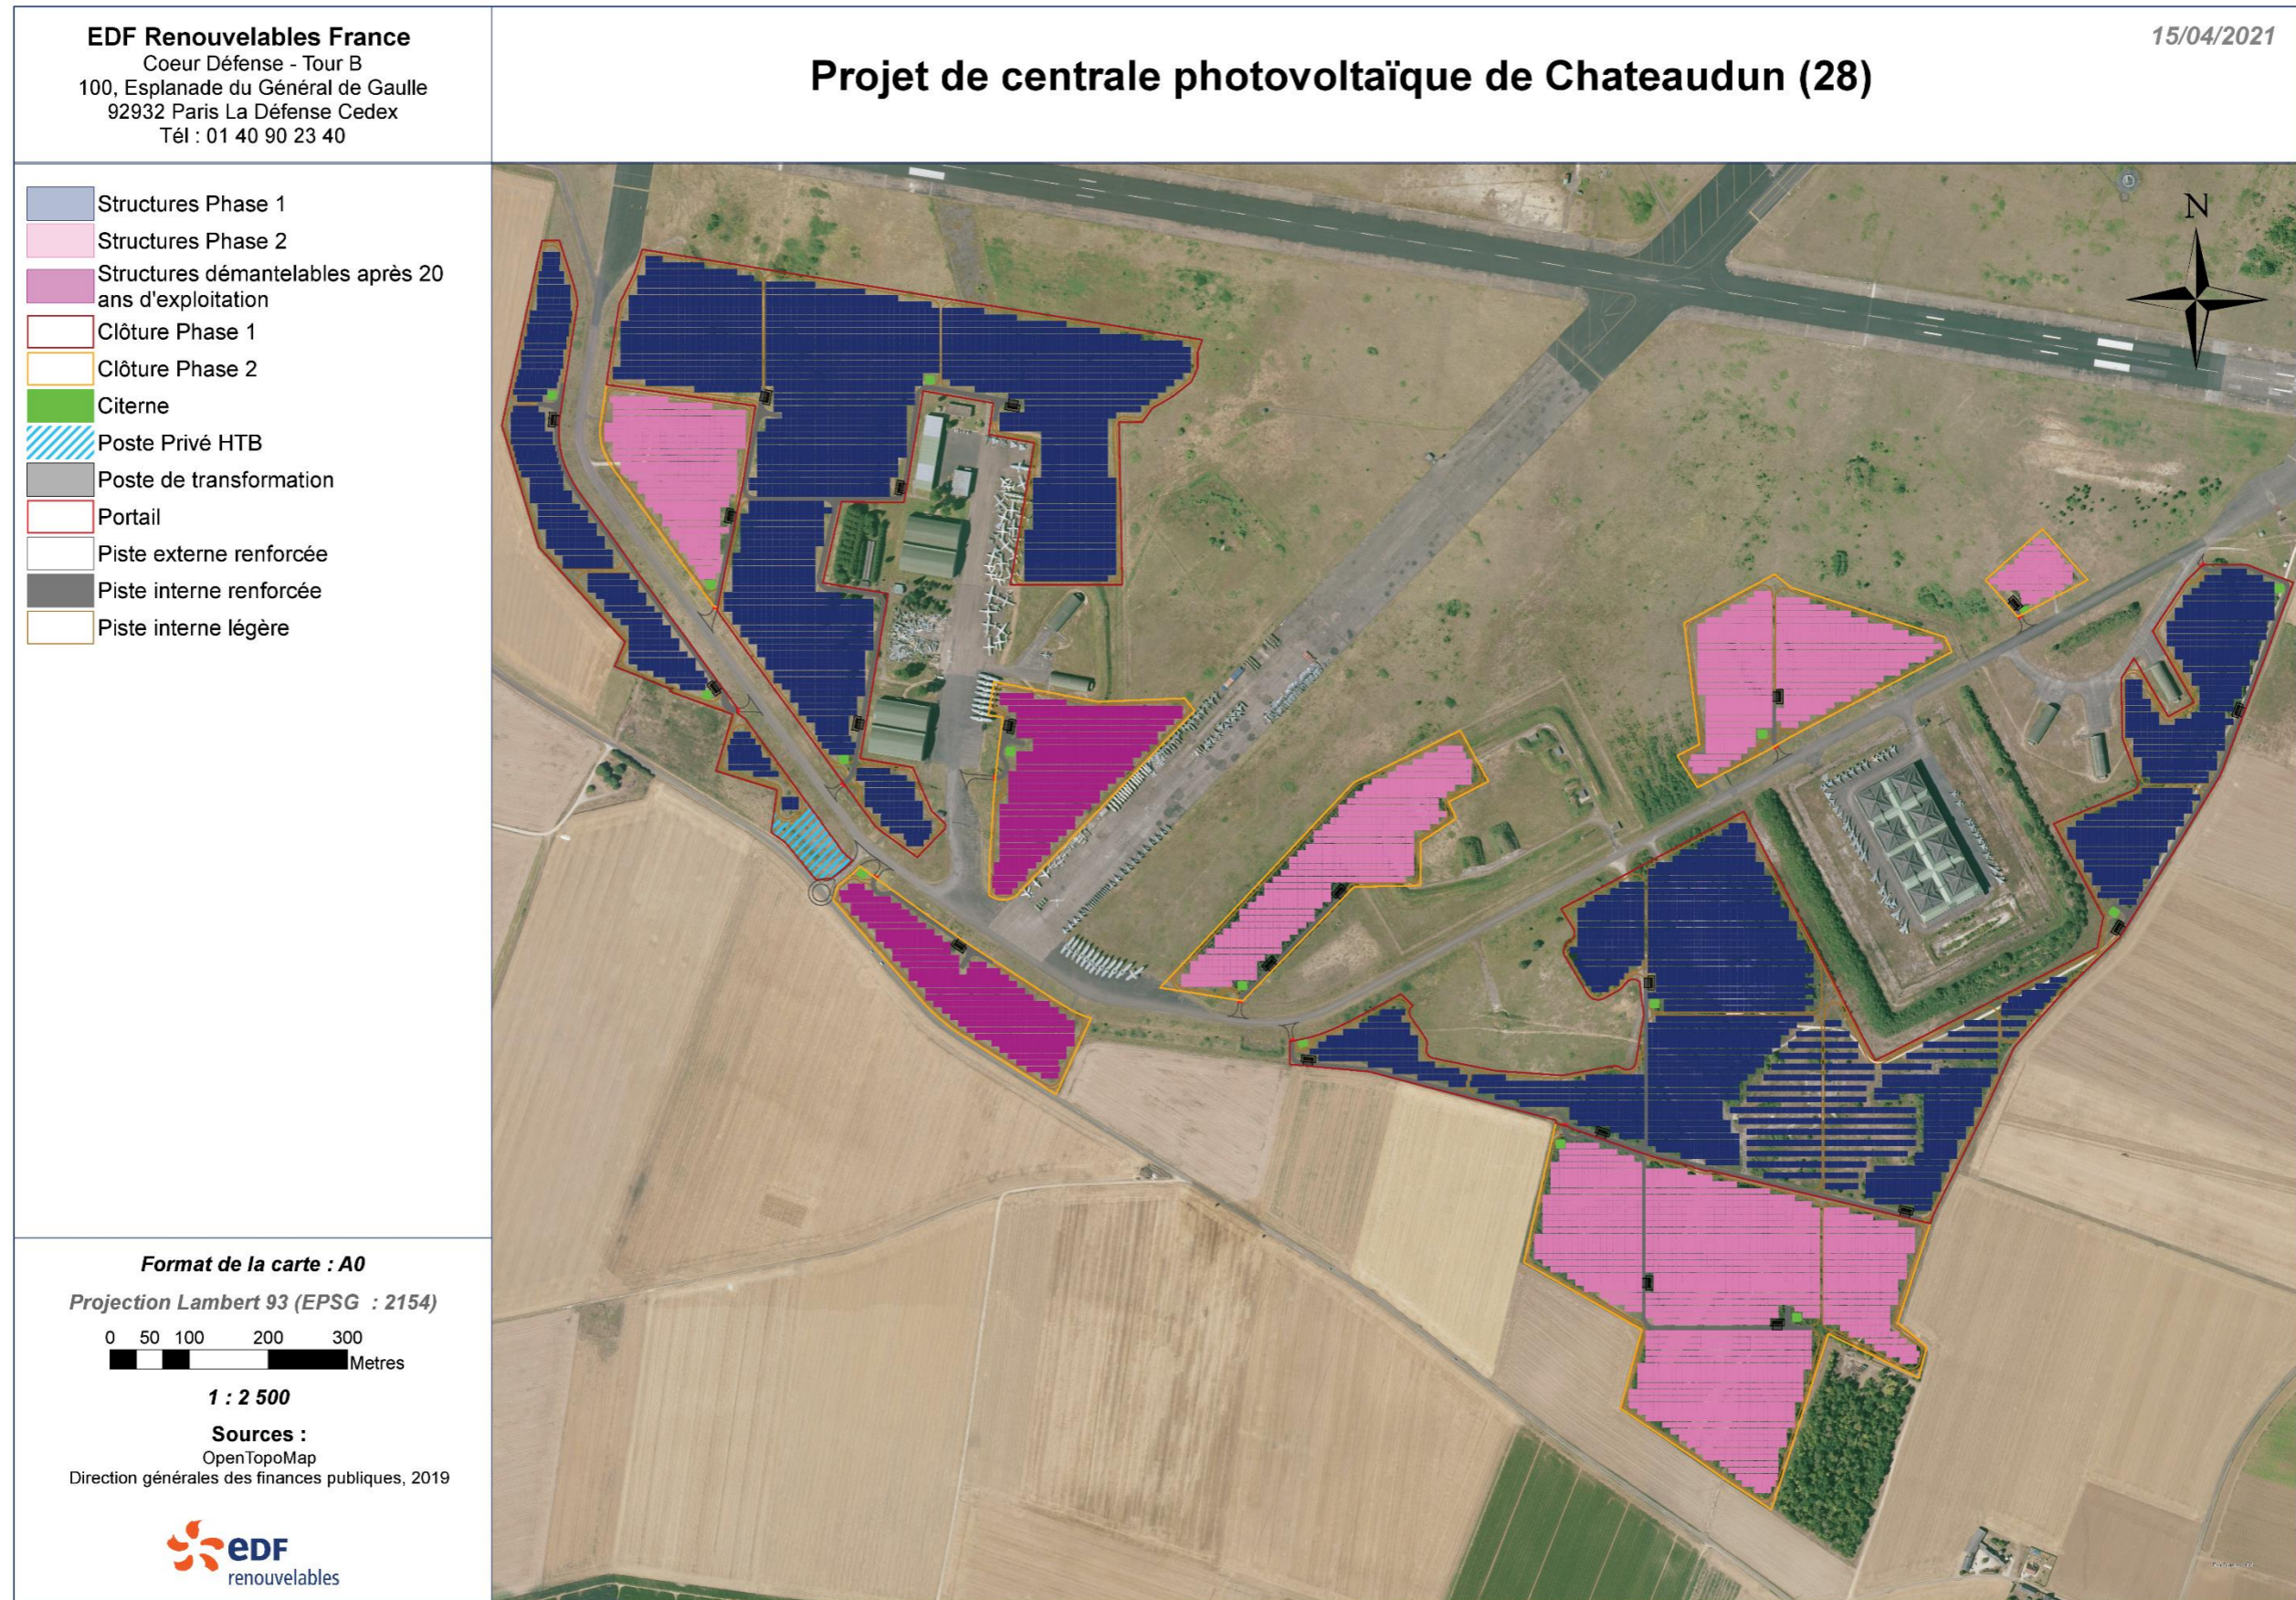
Plan de principe du projet (Source : EDF Renewables)
